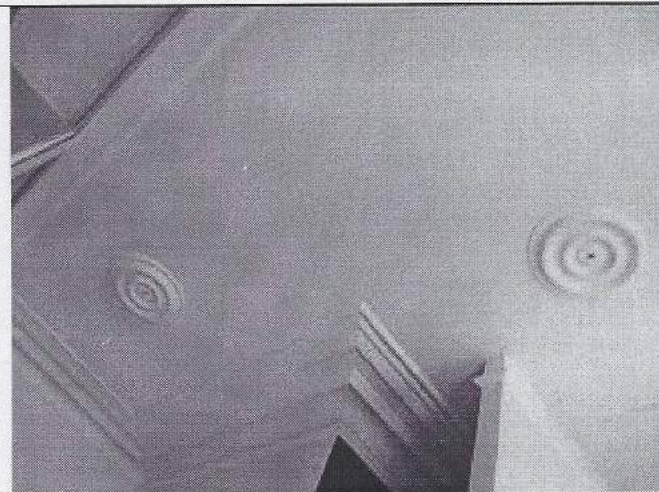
Профилированные тяги на потолке в помещении 2-го этажа
